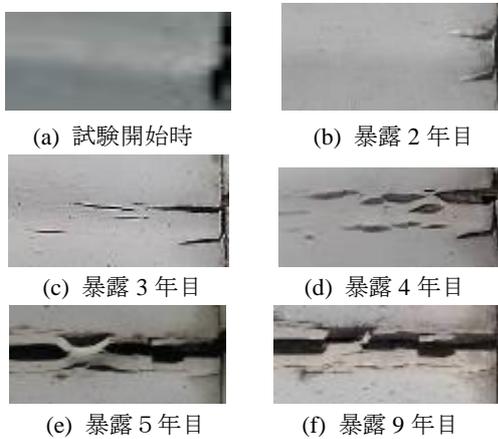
動暴露試験体の同じ位置の亀裂の進行 (ひび割れ幅 1.0⇔2.0 mm、塗膜厚さ 2 mm)
